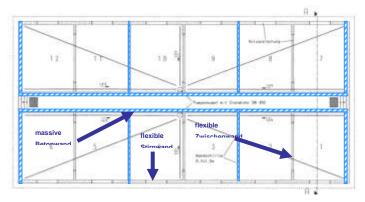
Grundriss Demonstrationsfeld
